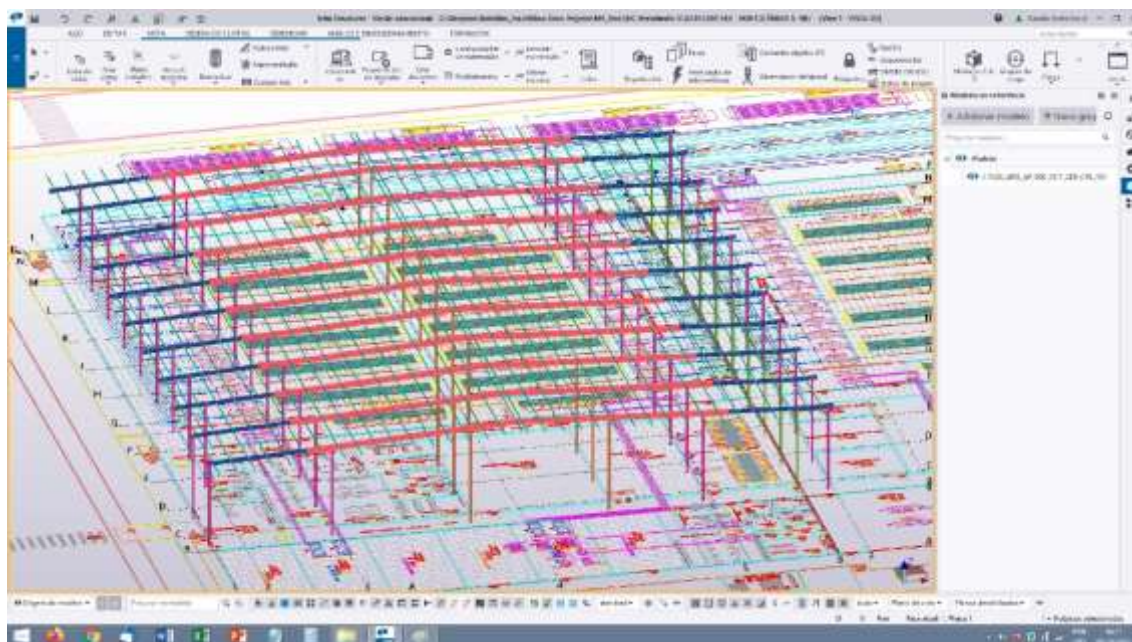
Importação da planta baixa para o *Tekla Structures*®
